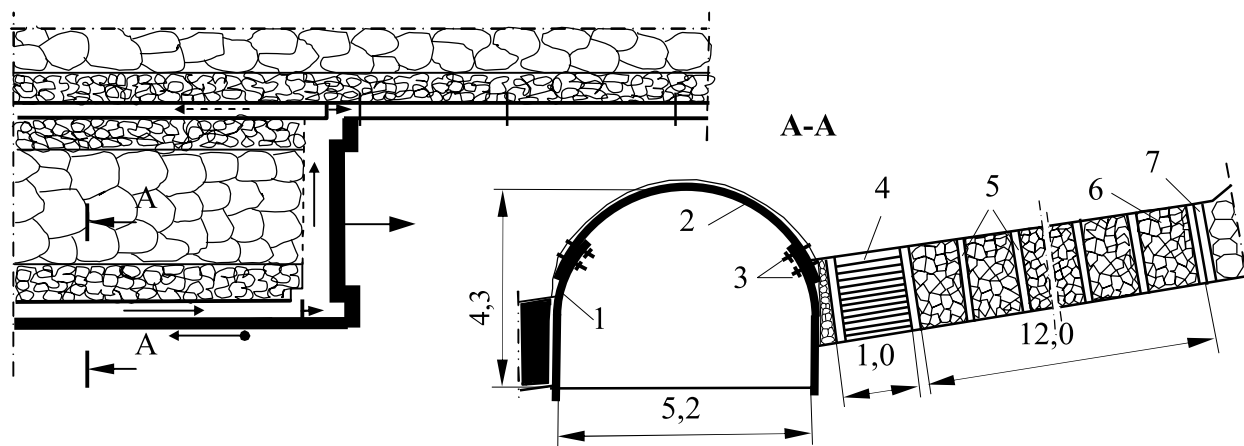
Способ охраны выработок бутовой полосой: 1 – стойка крепи; 2 – верхняя арочная крепи; 3 – замки крепи; 4 – чураковая стенка с укладкой рядов стоек на глине; 5 – стойки деревянной крепи; 6 – бутовая полоса из породы от проведения конвейерного штрека; 7 – обрезная органный крепь
